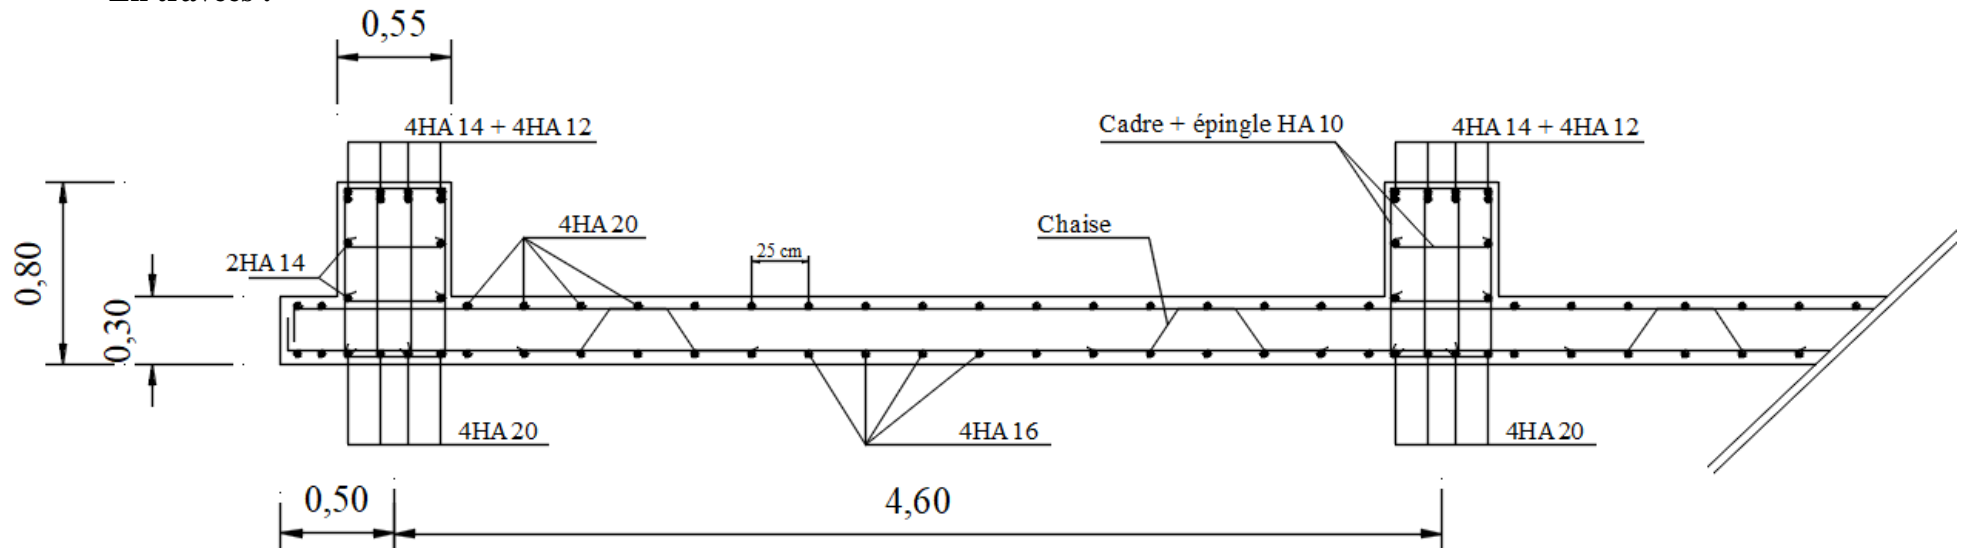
Schéma de ferrailage du radier (en travées) sens x-x.
